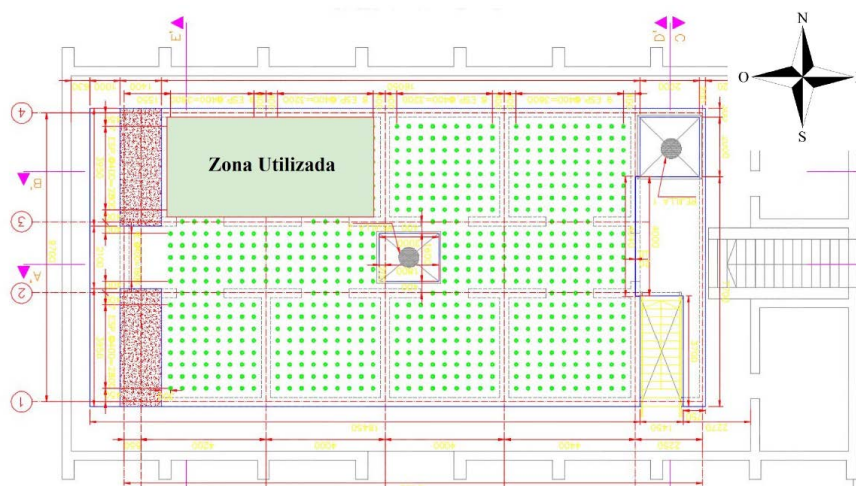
Planta Laboratorio de Estructuras y Zona Utilizada [11]
